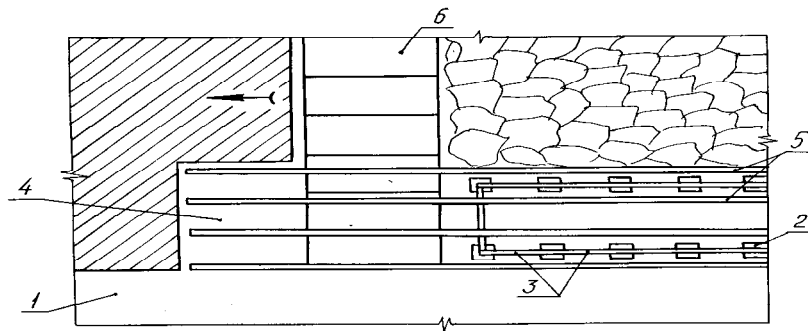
Способ охраны подготовительной выработки с регулируемым параметром – площадью контакта ОУ с кровлей
